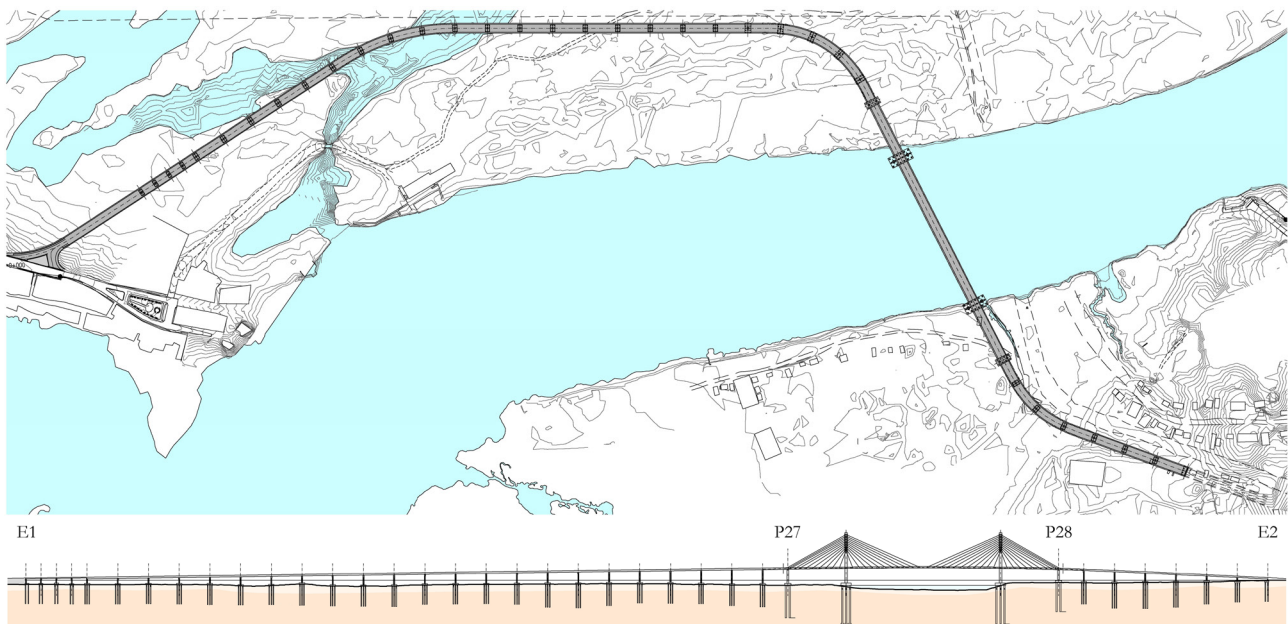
Planta y alzado del puente sobre el río Nanay y de los viaductos de acceso.
